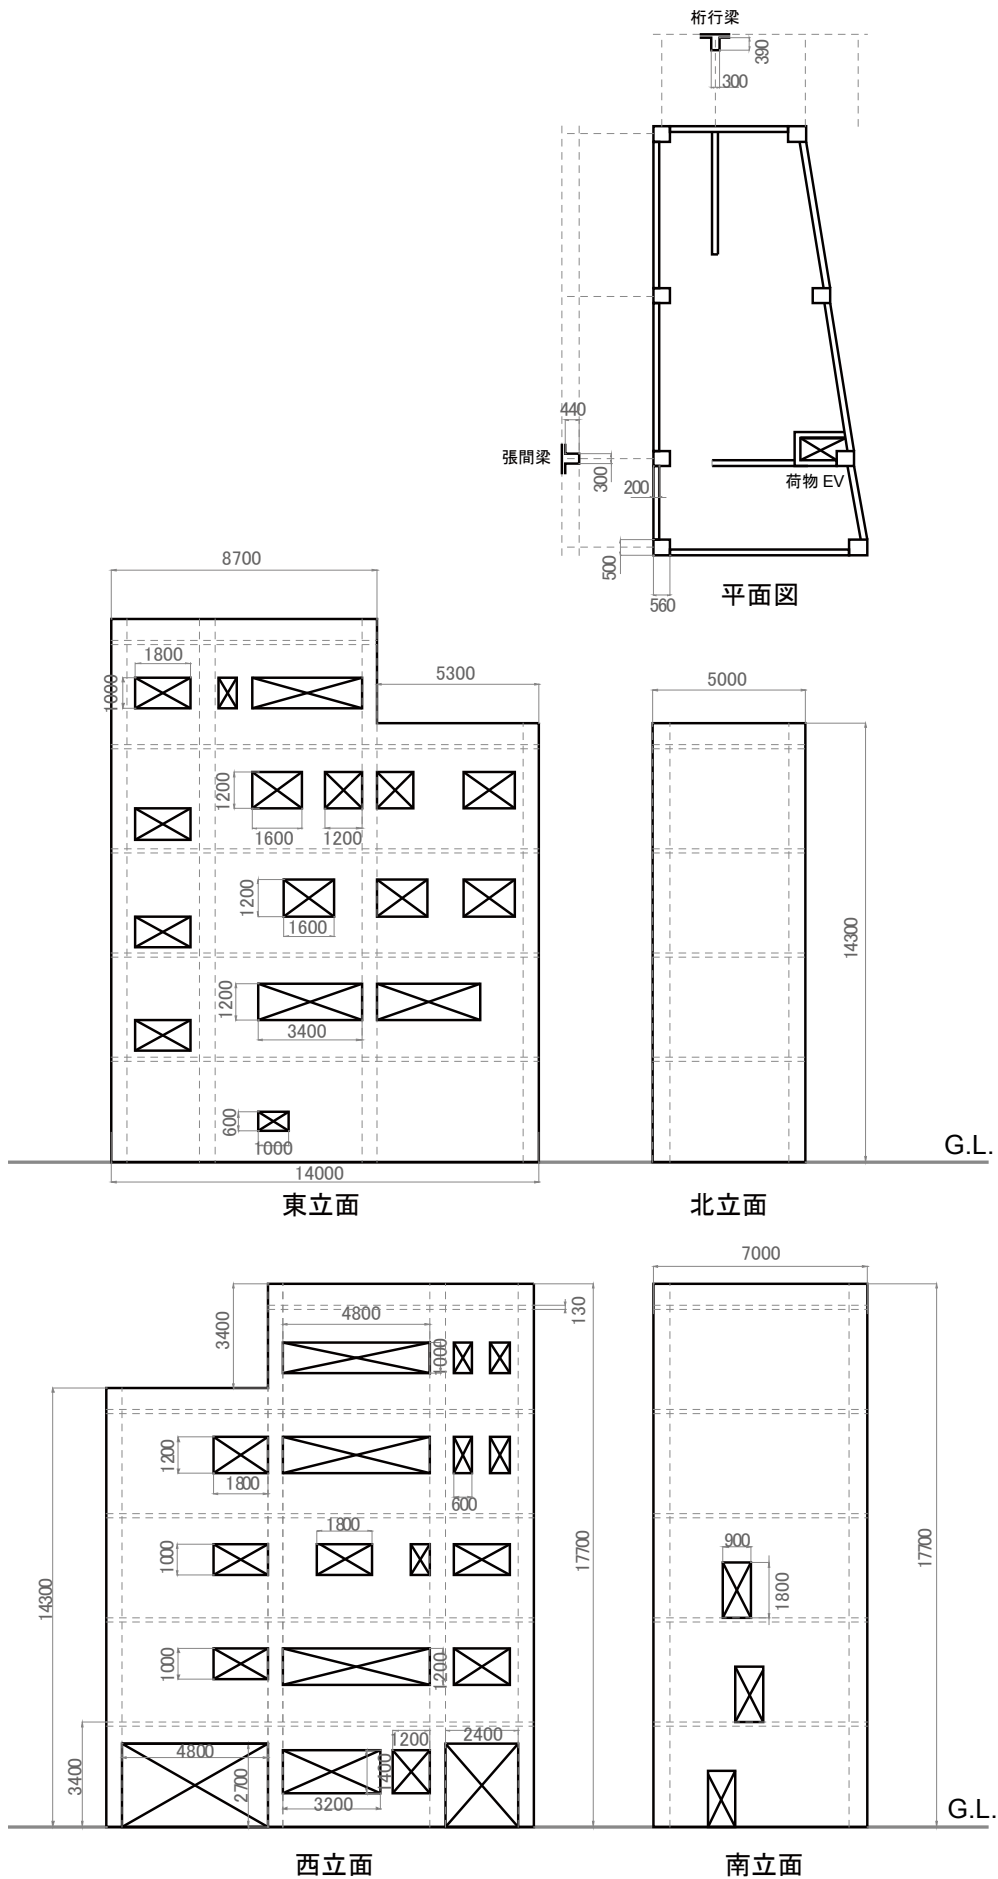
調査対象建物 立面図・平面図 (単位: mm)
